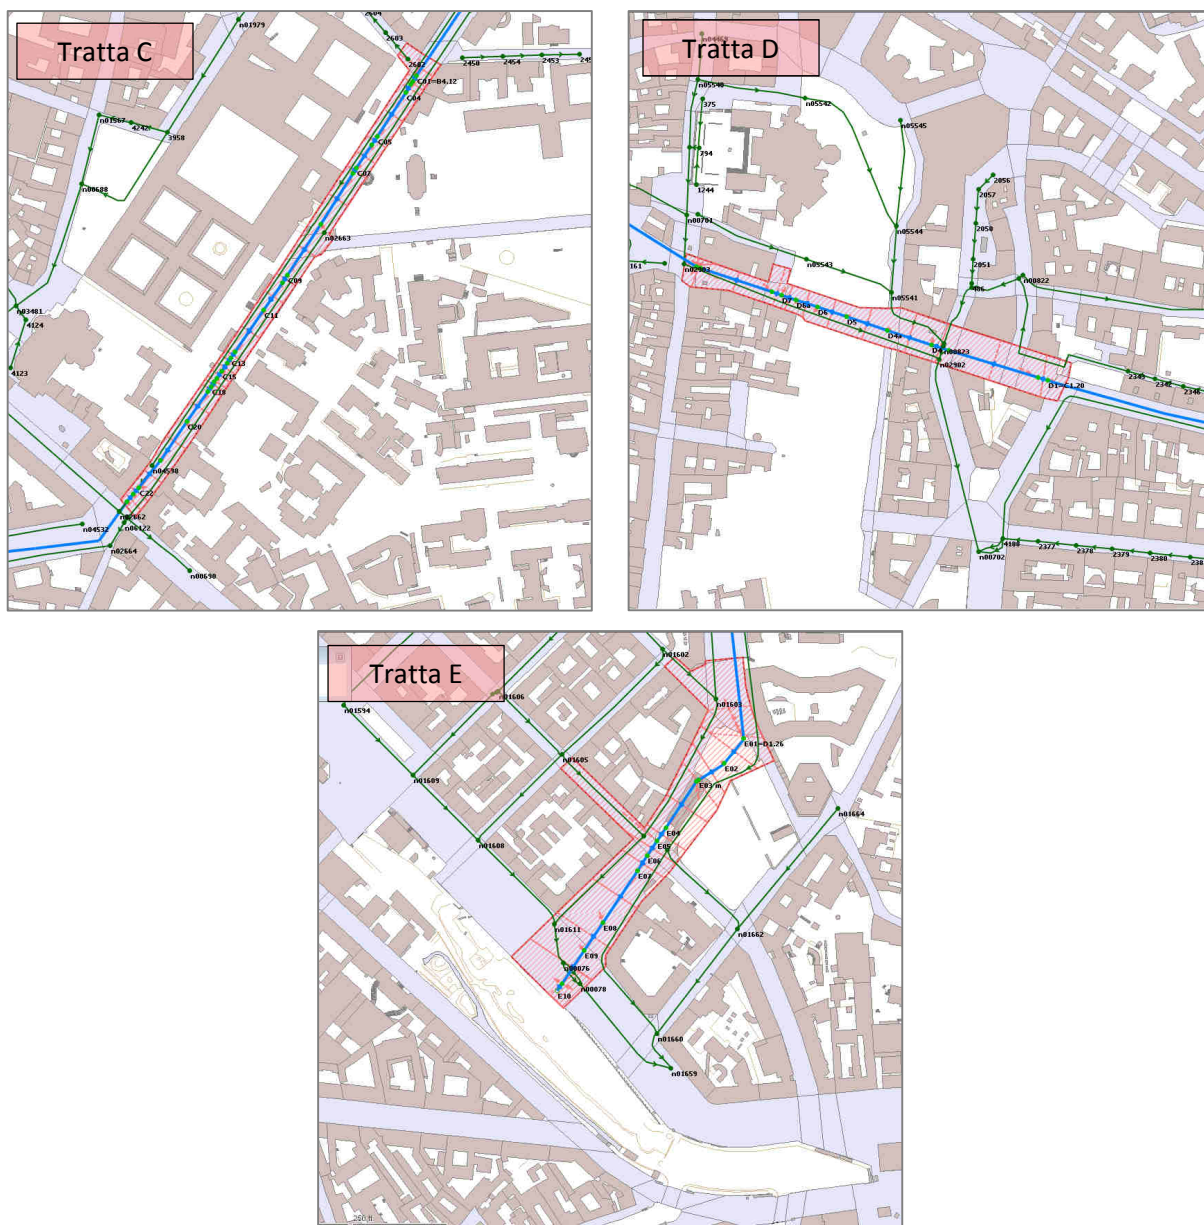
“Planimetria dei bacini afferenti alle 5 tratte oggetto di riapertura”
